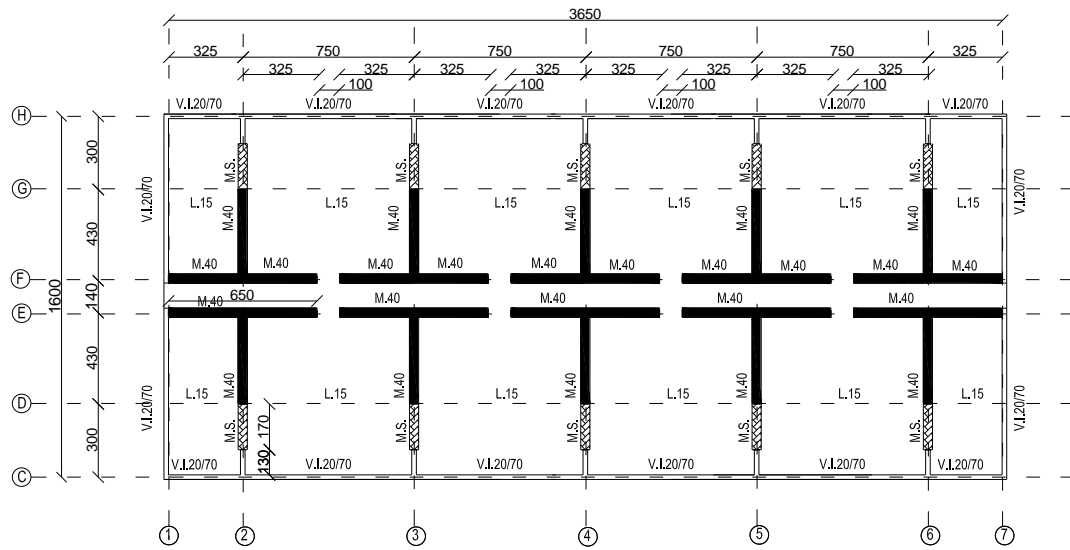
Planta estructura nivel 1º, edificio tradicional.
